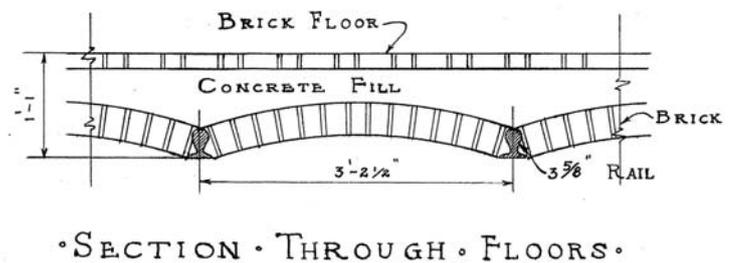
6: Fußbodenaufbau der Nassau Hall
